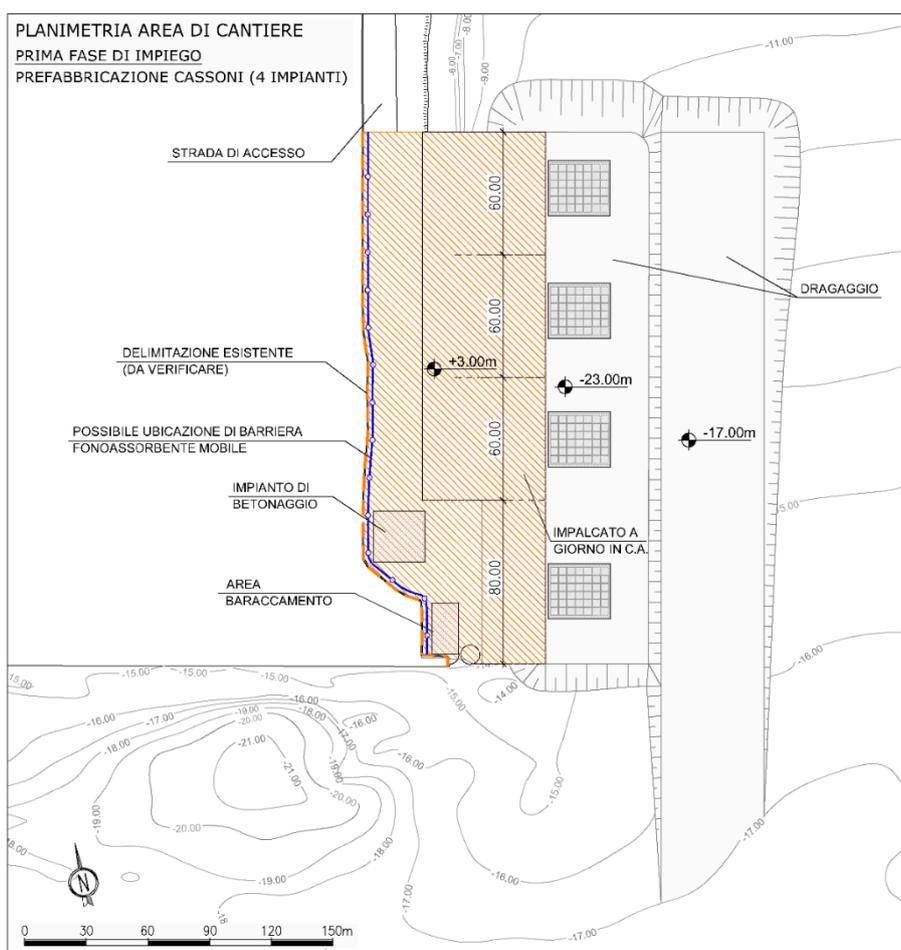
PLANIMETRIA AREA DI CANTIERE DI PRÀ-VOLTRI. FASE A): MACROFASE 1
